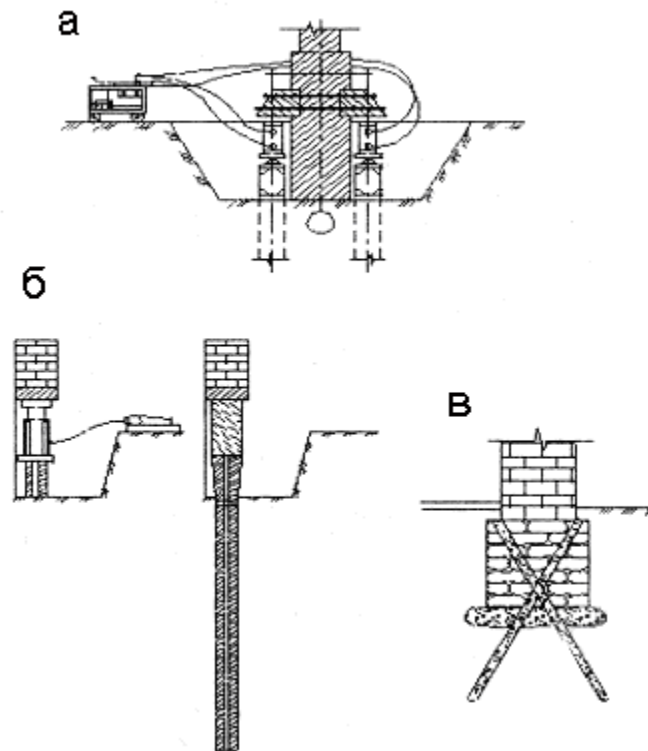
Підсилення фундаментів із застосуванням паль:
